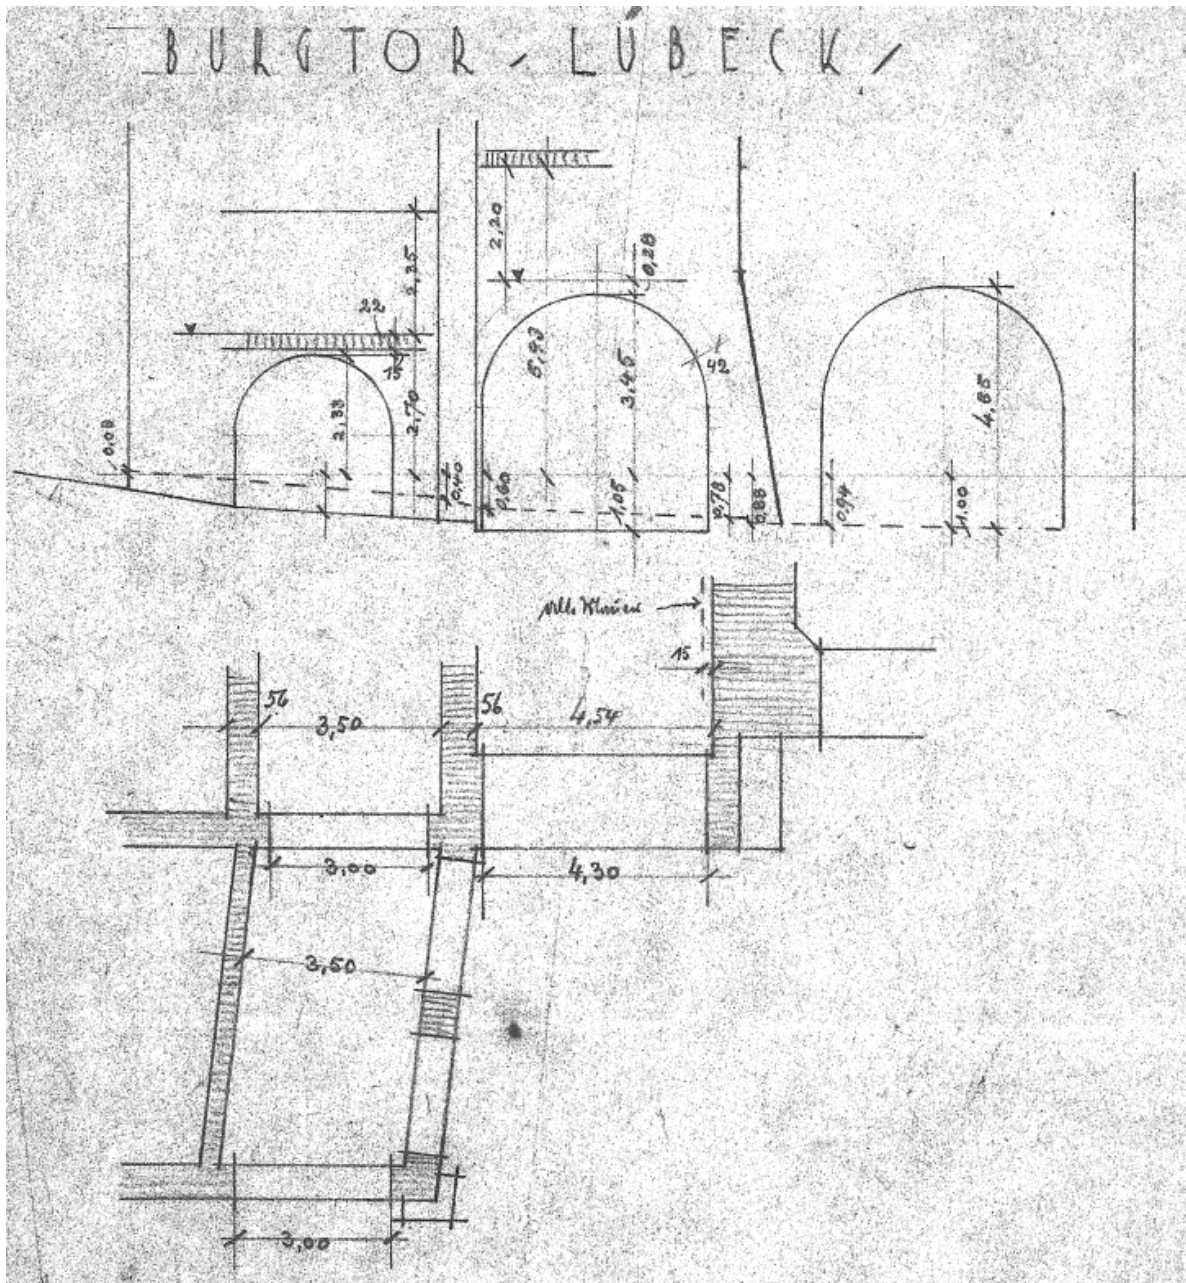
Burgtor, historischer Plan mit Dimensionen Nr. 2 (genaues Datum unbekannt)
